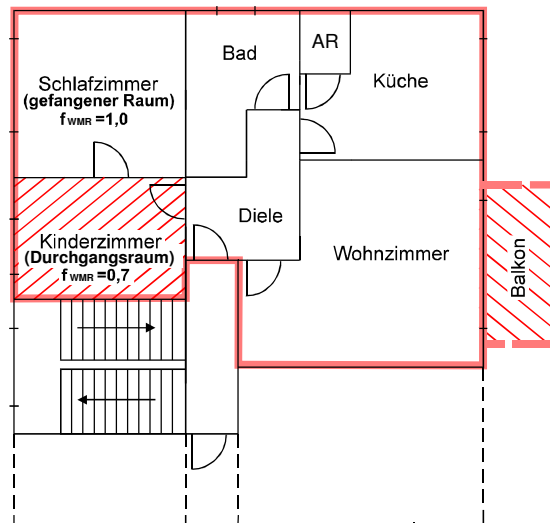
Wohnungsgrundriss des Bewertungsobjekts
